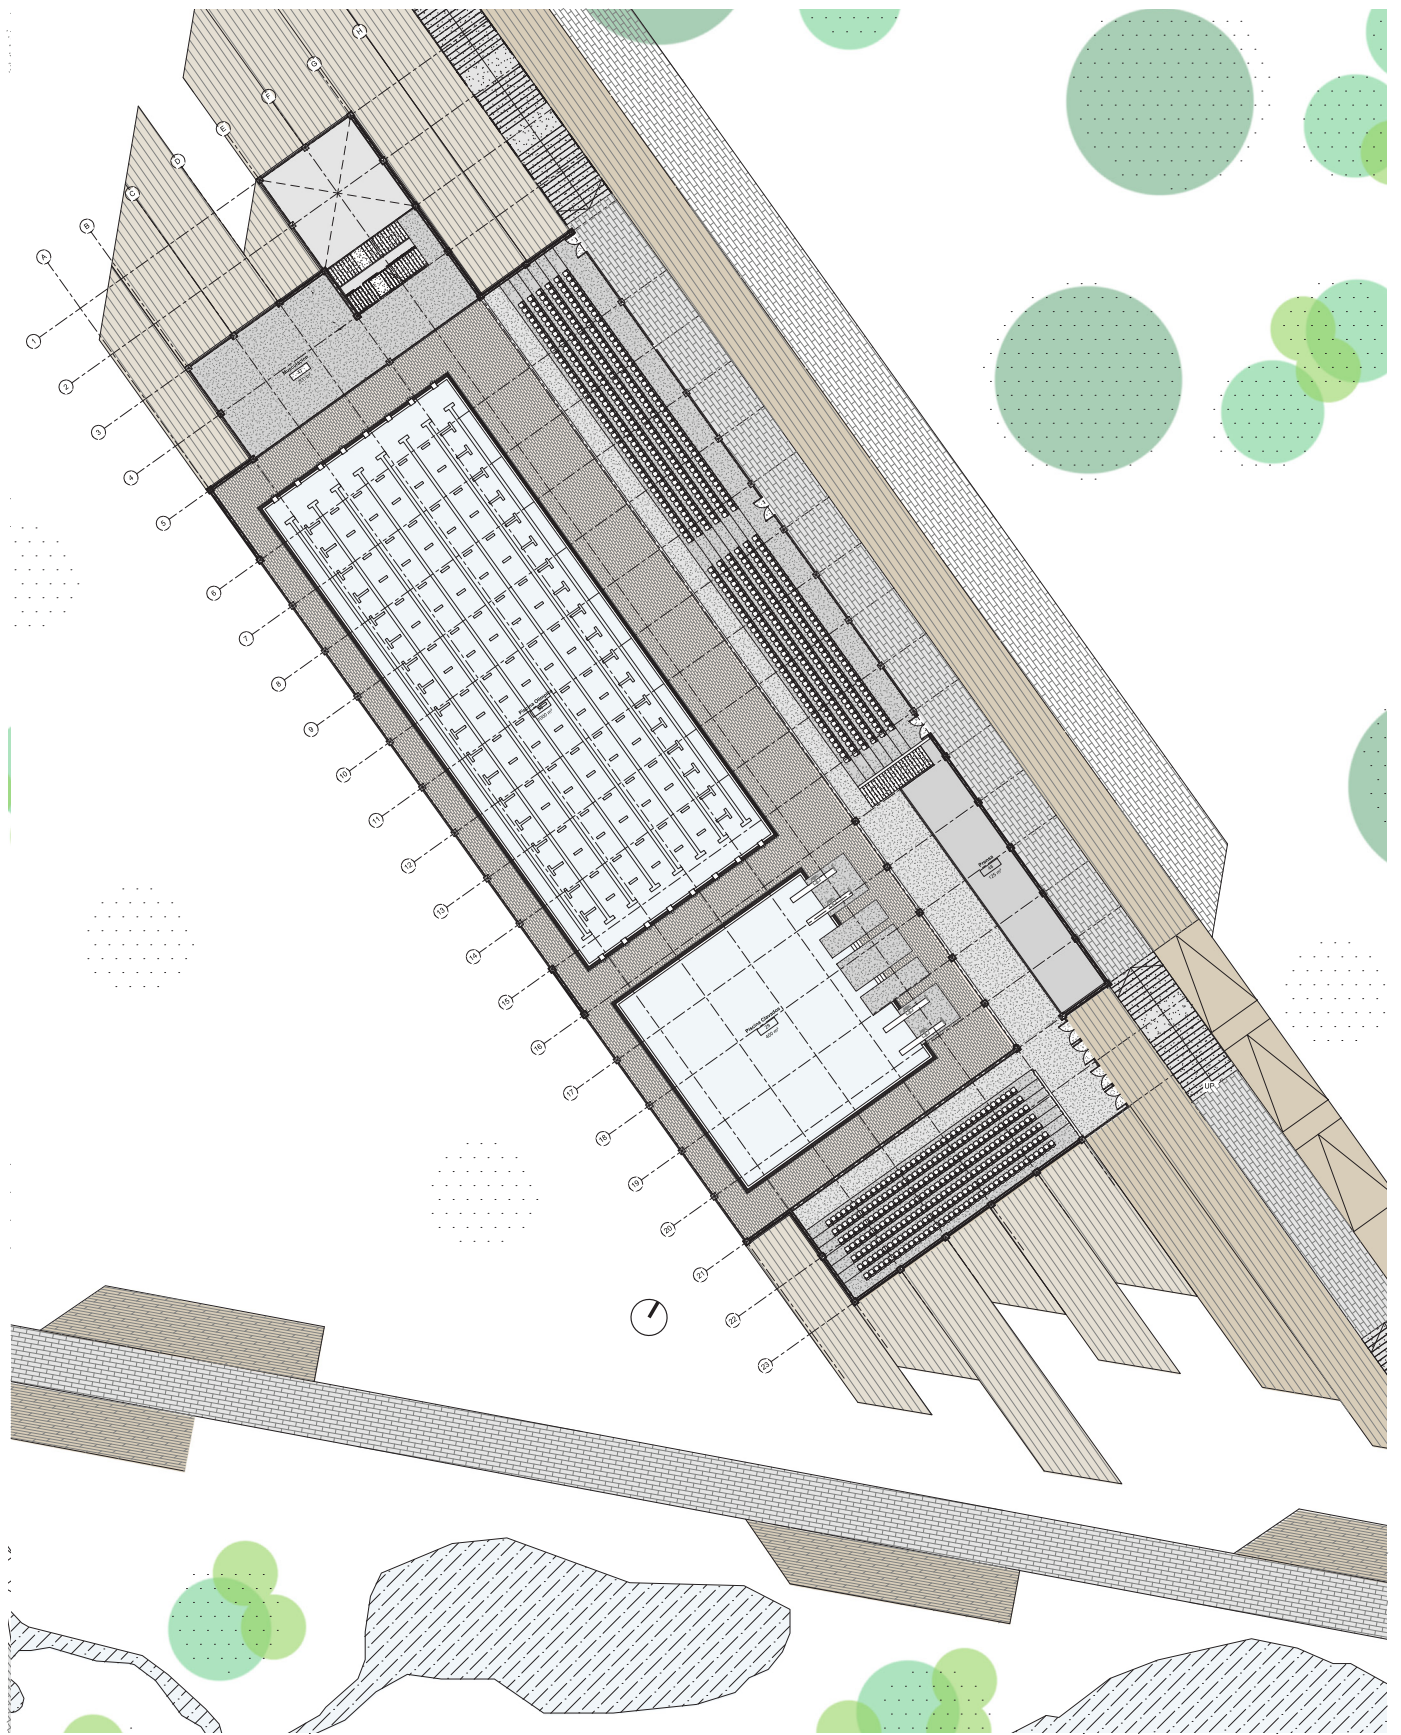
\_ Planta Centro Acuatico NPT+3.0 V2
